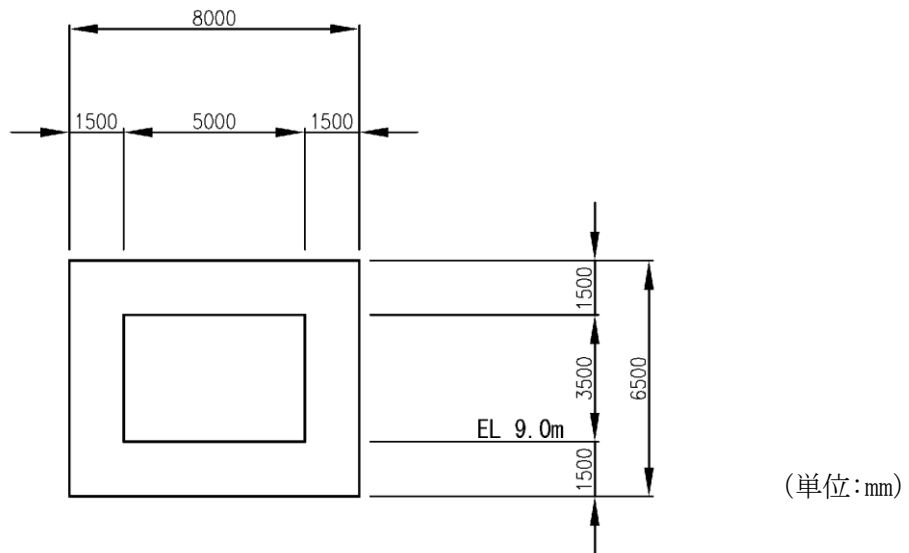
低圧原子炉代替注水ポンプ格納槽 断面図 (D-D断面)
